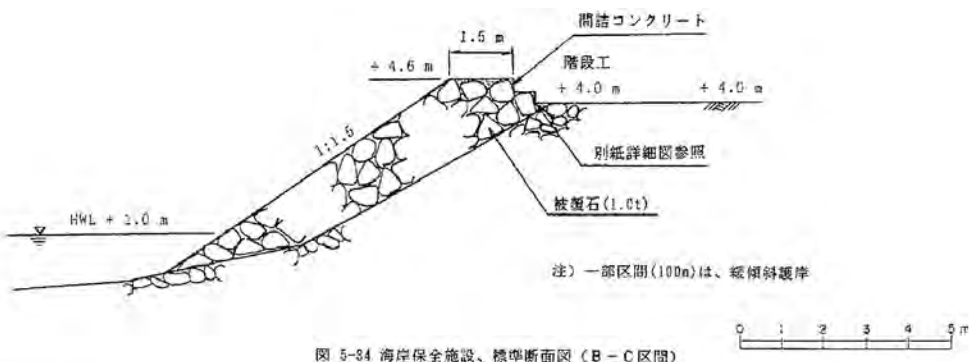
海岸保全施設、標準断面図 (B-C 区間)
